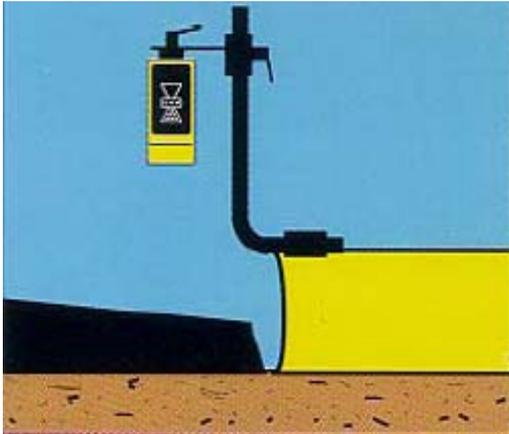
Sistema Ultrasonido referido a un Pavimento existente.
